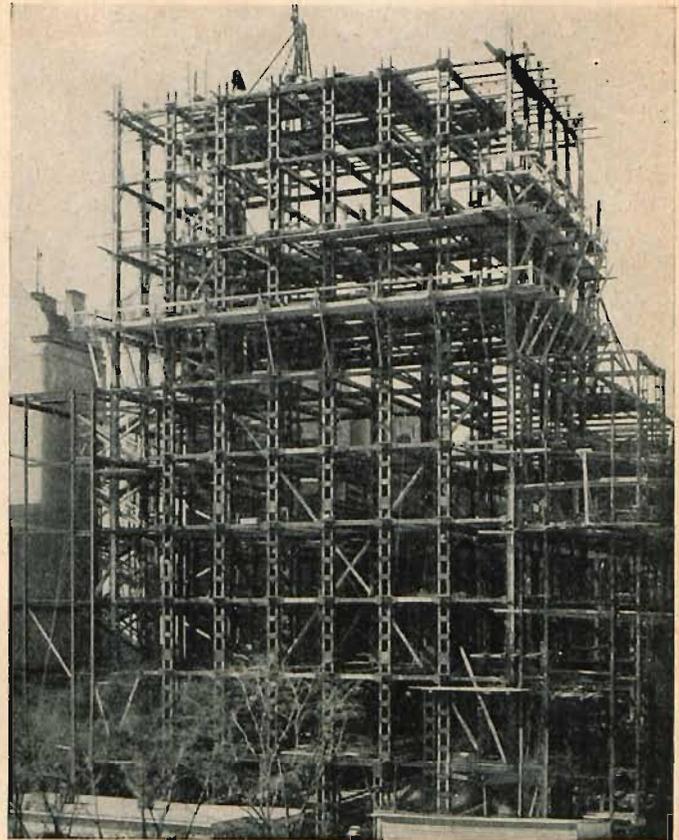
Stahlkonstruktion des Turmes während der Ausführung.
